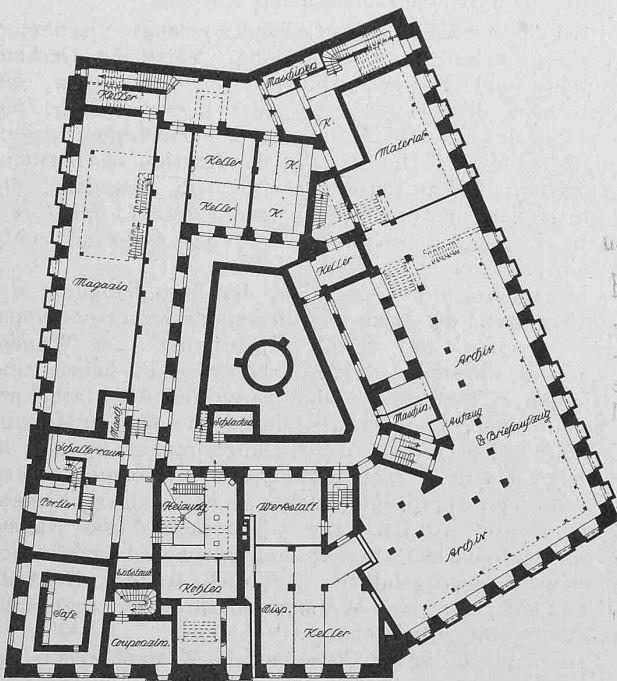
Grundriss vom Untergeschoss. — 1:600.
